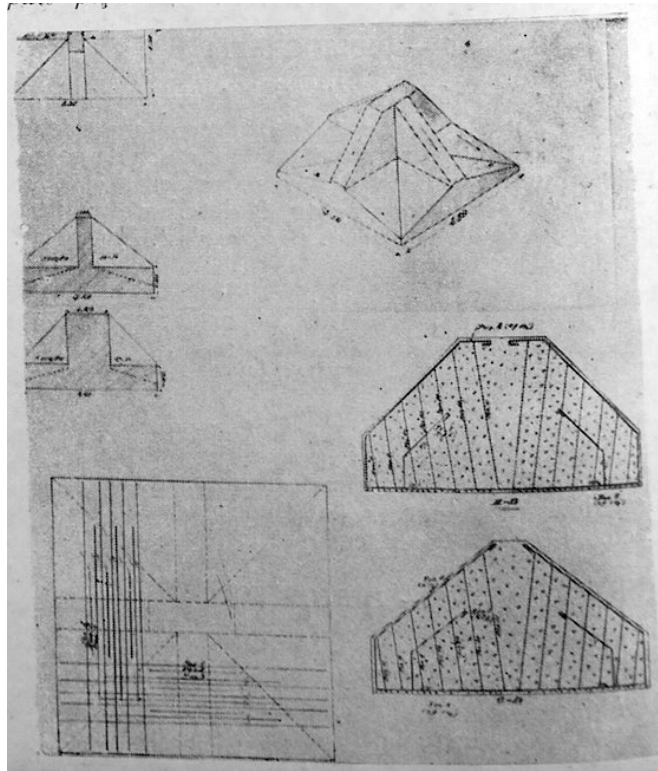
Desenho técnico das sapatas. FONTE: CONCRETO, 1938.
